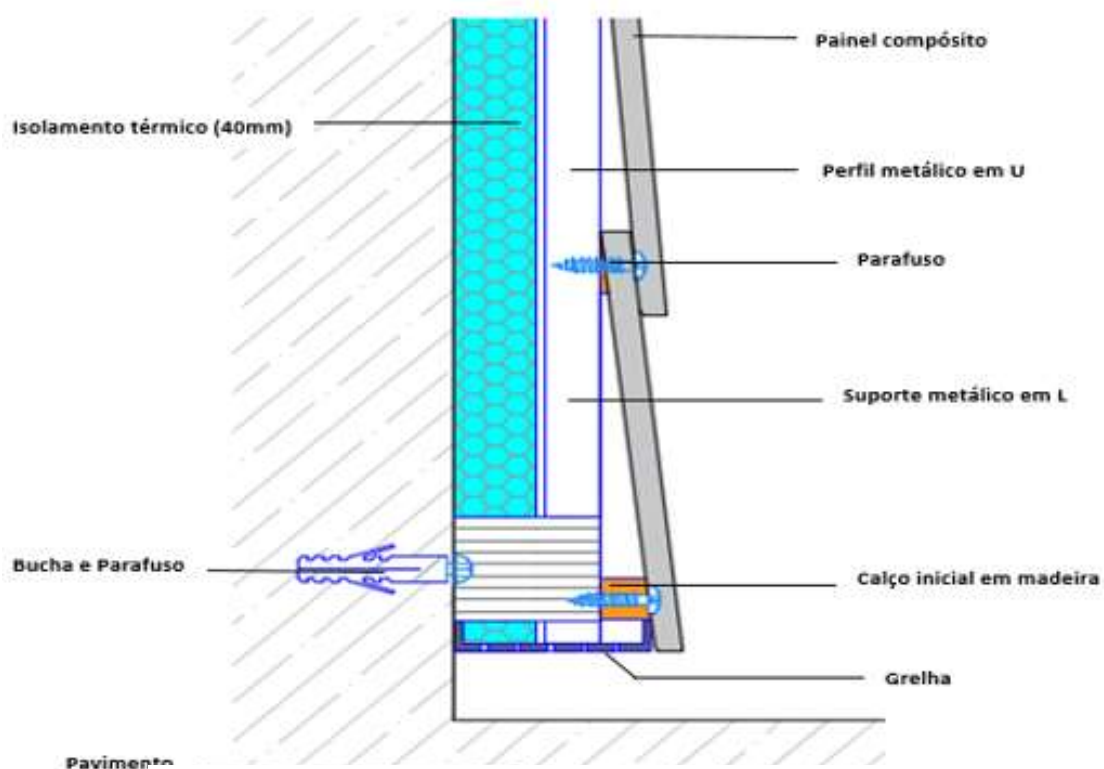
Pormenor construtivo nº 6, revestimento sobre o solo.
